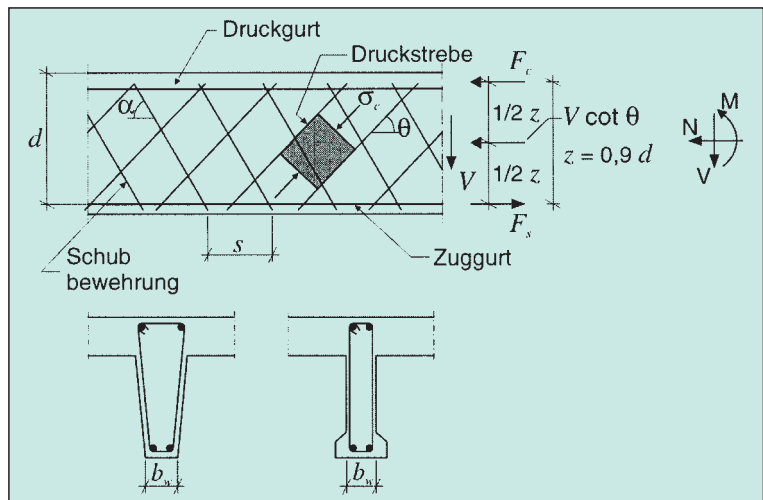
Bezeichnung für querkraftbeanspruchte Bauteile
